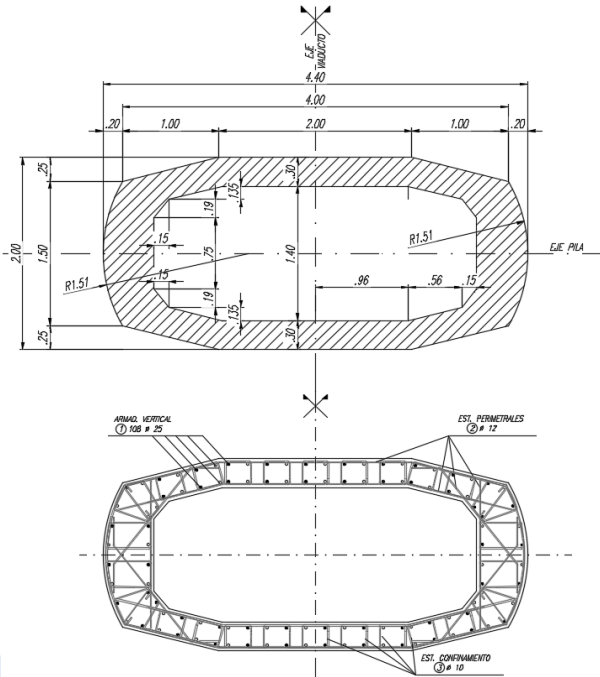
Sección transversal de una columnas (proyecto y construcción)
